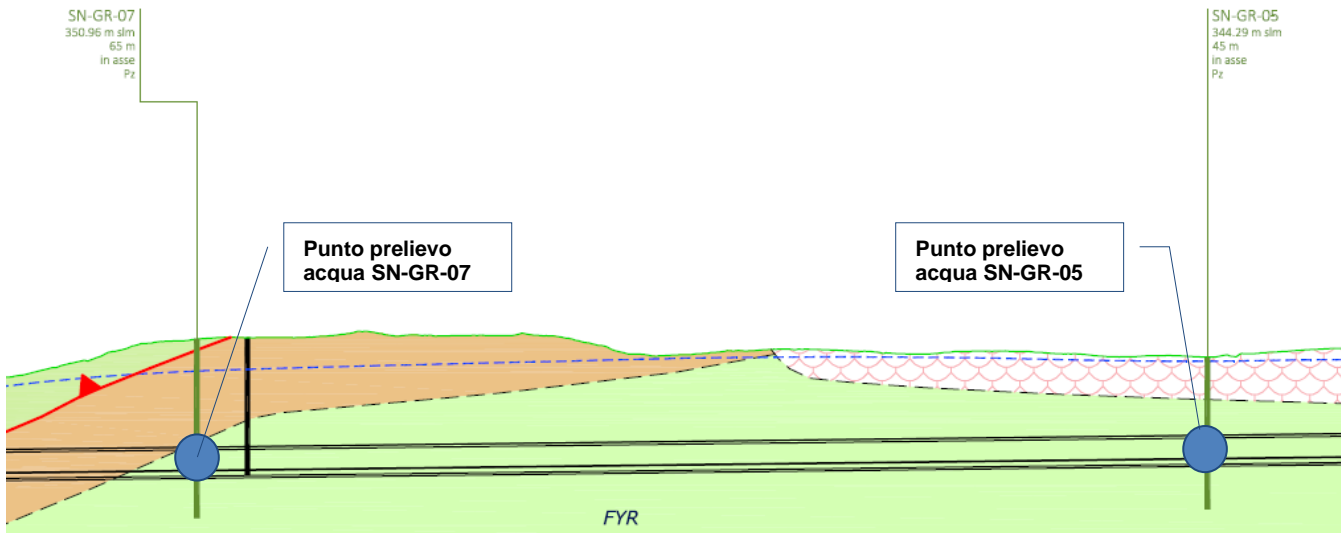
Galleria Grottaminarda: Posizione Piezometri SN\_GR\_05 e SN\_GR\_07 rispetto alla galleria
